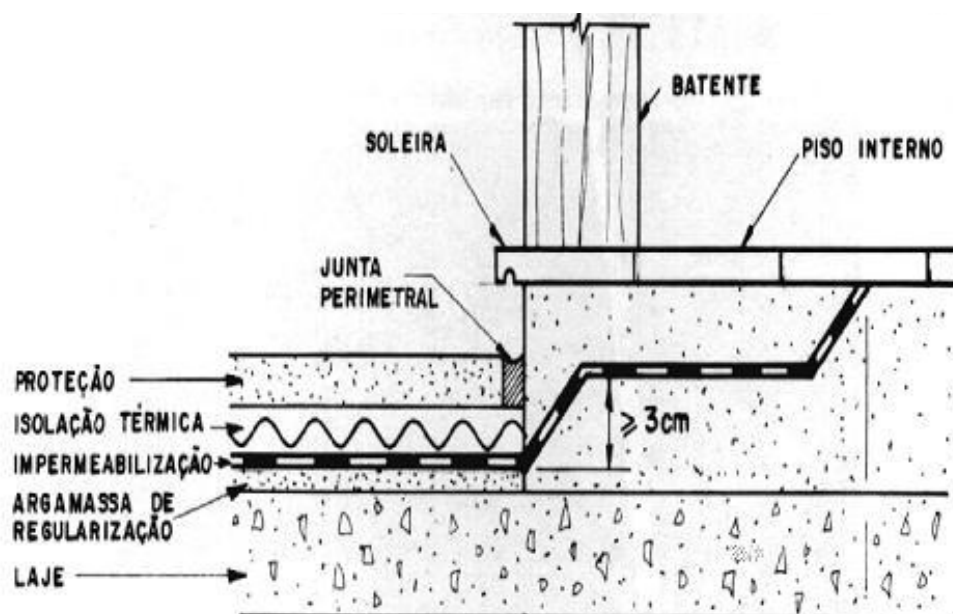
Pormenor de impermeabilização de batente de porta exterior.
